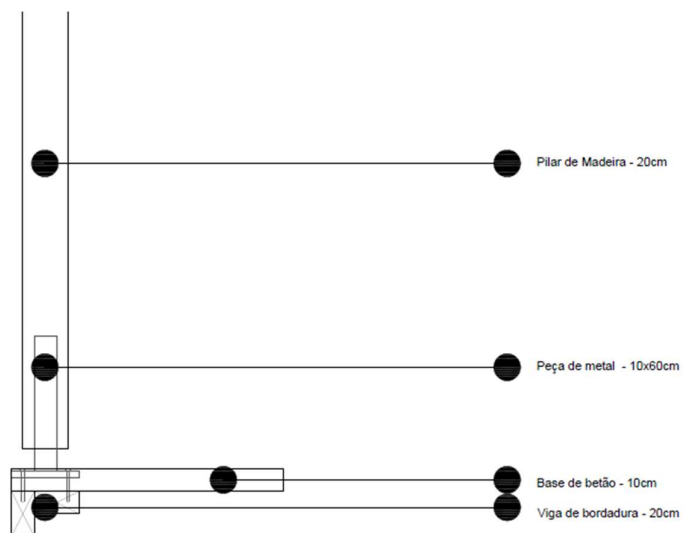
Detalhe do pilar de madeira do café proposto realizado pela autora em 26/06/2025
